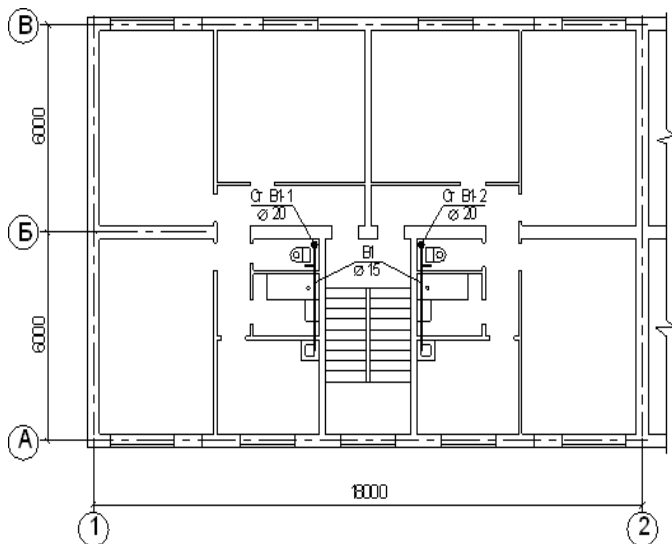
План типового этажа с указанием сетей В1.
